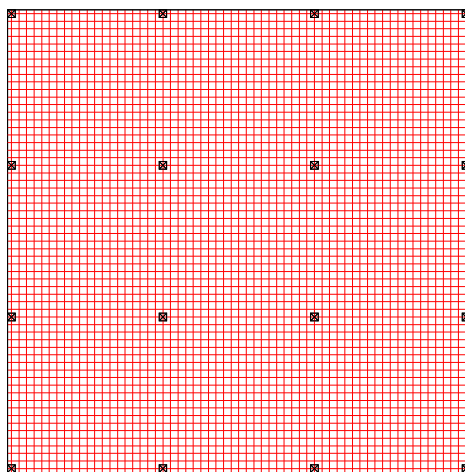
Alternativa de traçado 3 dos cabos no pavimento sem balanço
